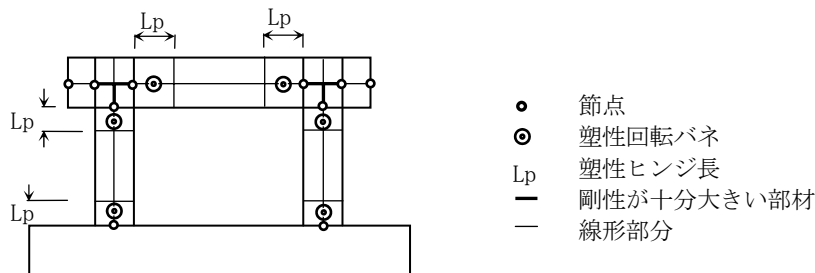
鉄筋コンクリートラーメン橋脚のモデル化
